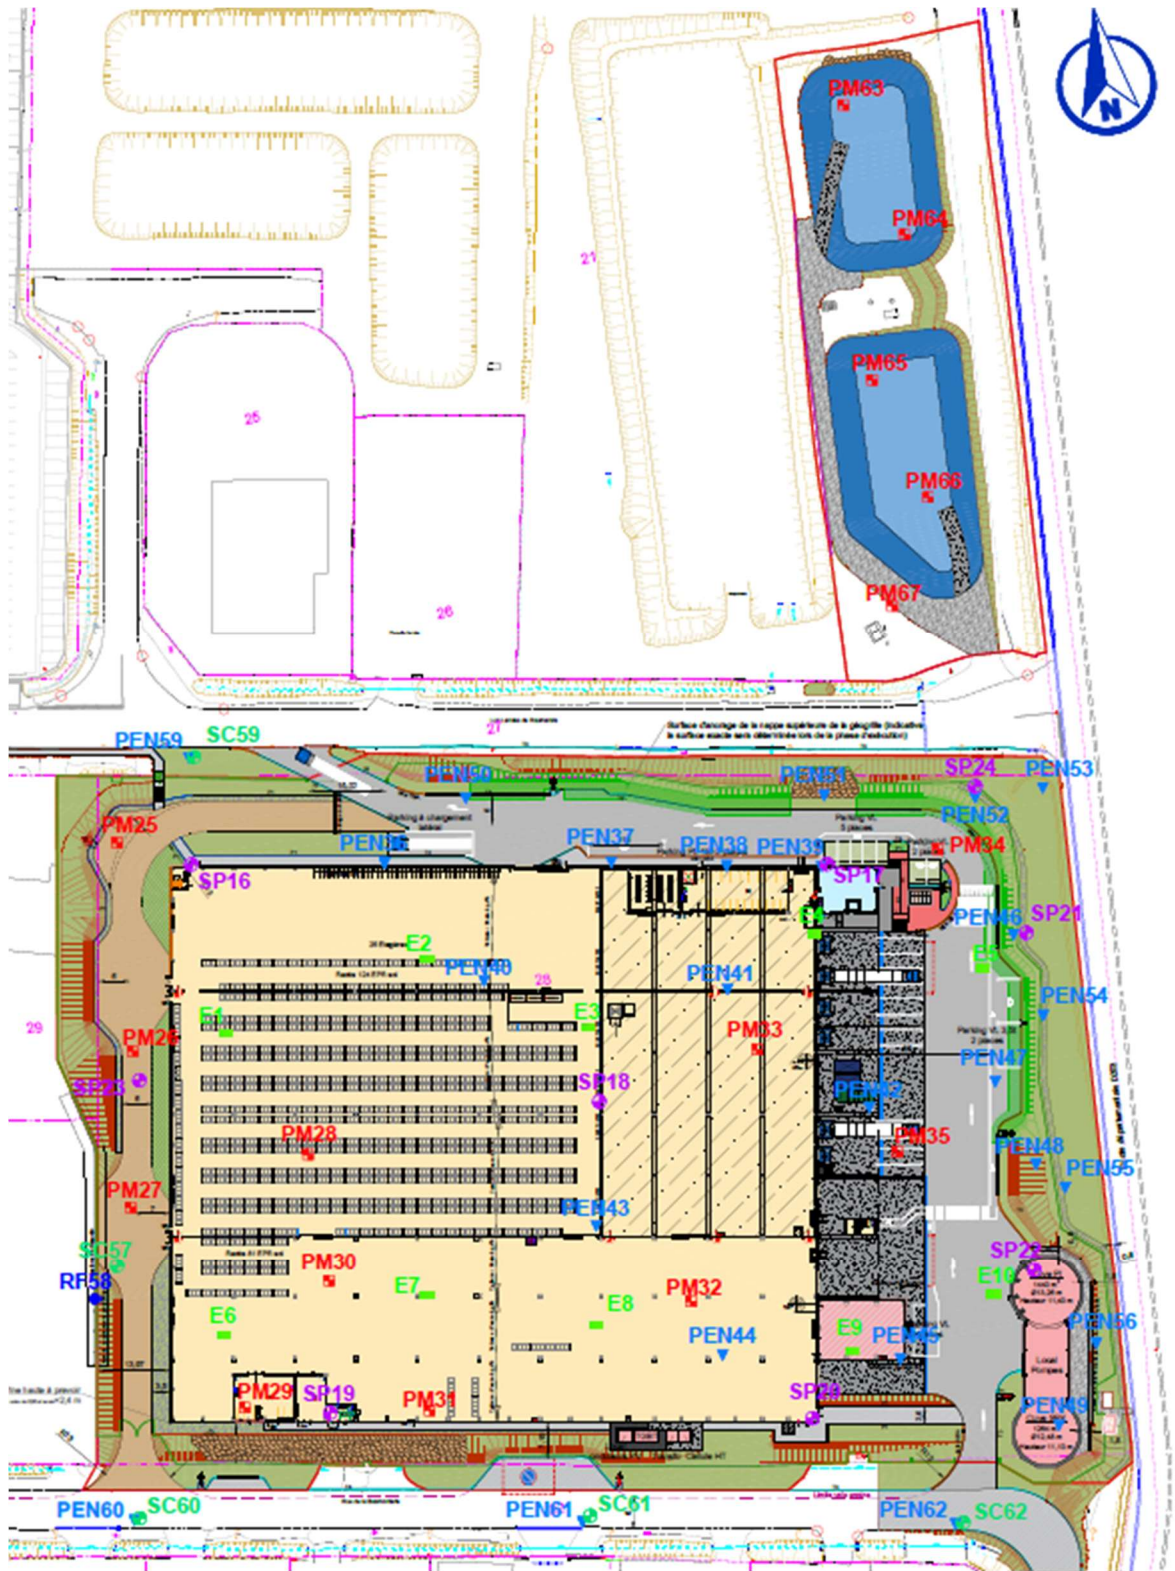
Plan d'implantation des sondages (Fin avril à fin mai 2025 dans le cadre de la G2AVP)
